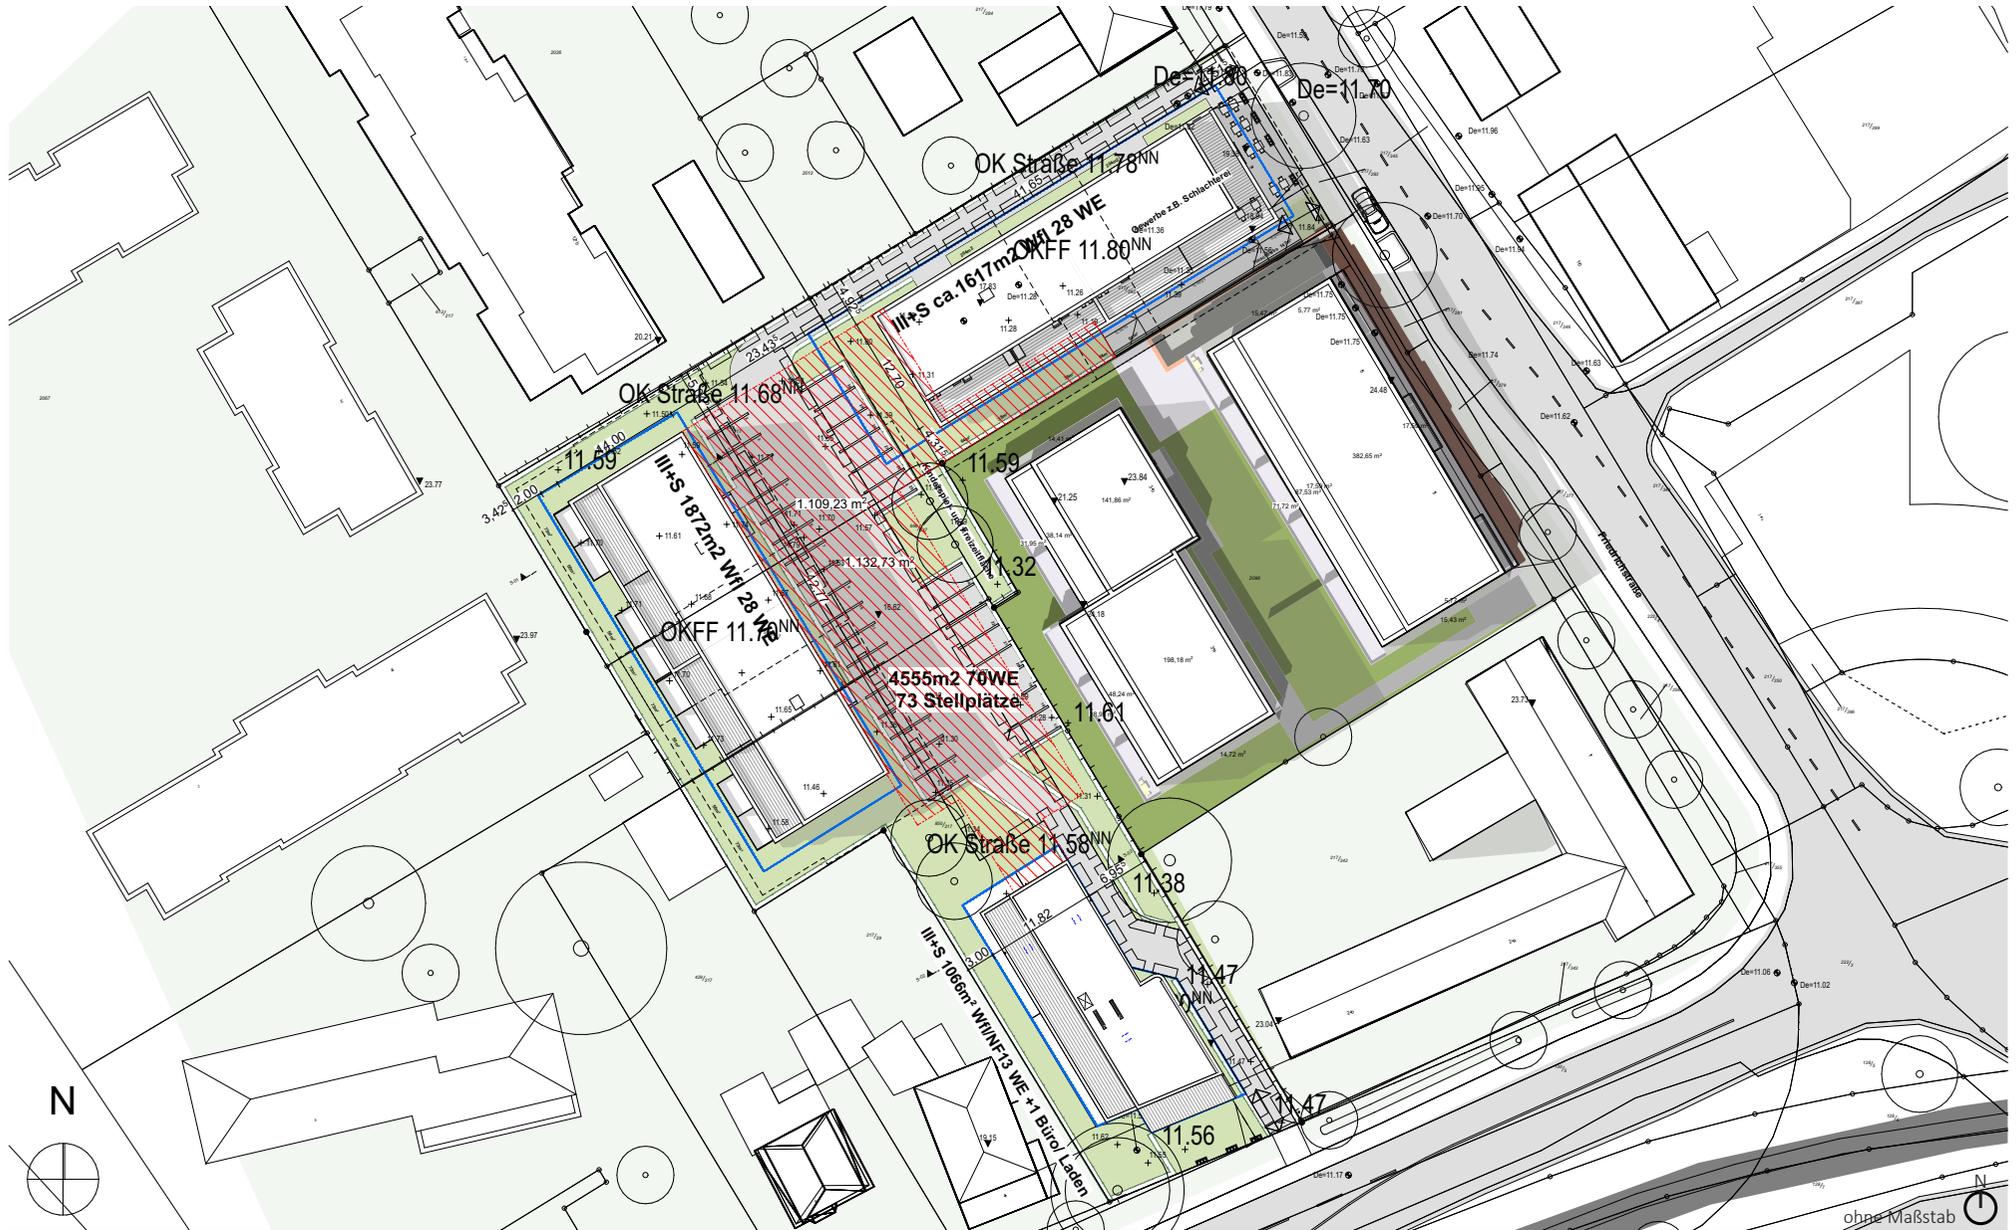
Ausschnitt Lageplan (Hansmann Heitgerken Architekten, Stand: 25.05.2023)
